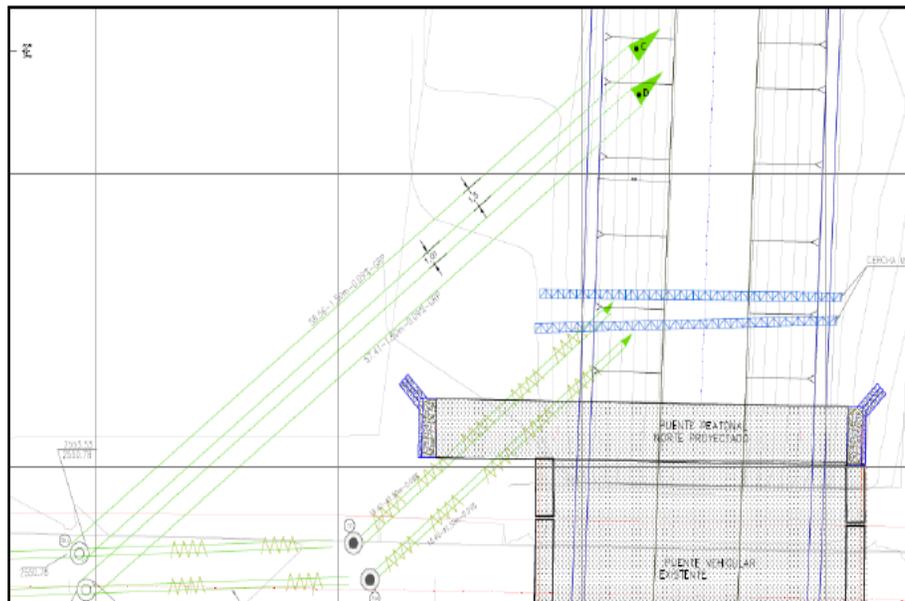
Ubicación general de la tubería existente y la nueva a construir en el sector oriental del canal Torca – Tubería 1.50 m.
